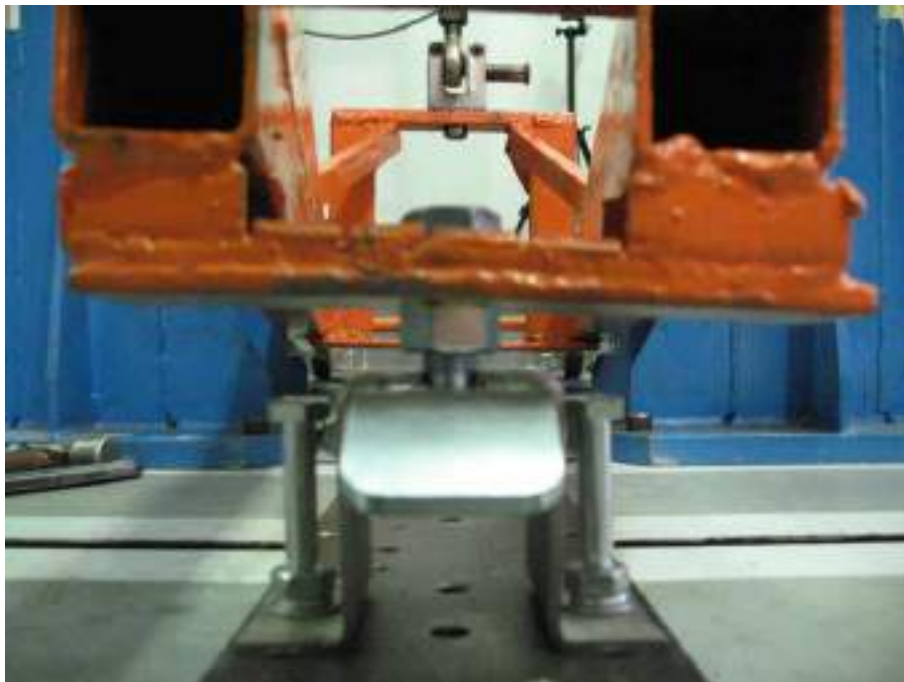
Lado esquerdo da amostra 1 após ensaio.
